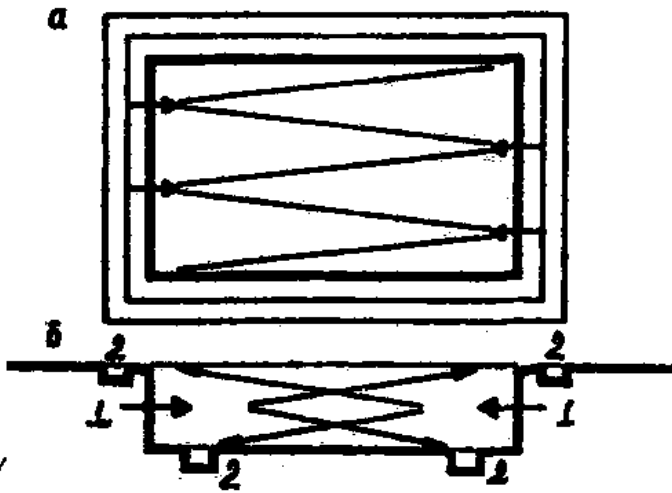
Подвійна поперечна течія: а) – план; б) – розріз
